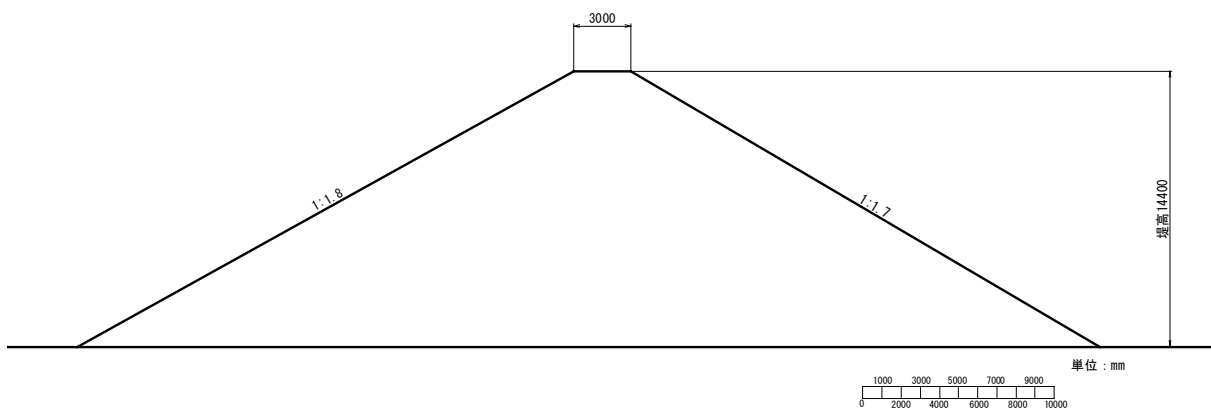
施工コスト算定用現況堤体断面-3 (H=14.4 m)
